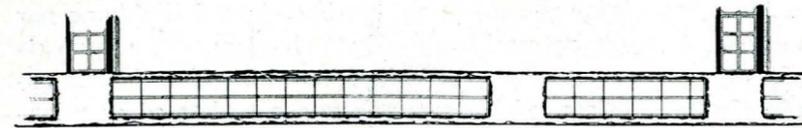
Variante del maschio del muro perimetrale a doppia soletta con mattoni cavi - Sezione verticale.
